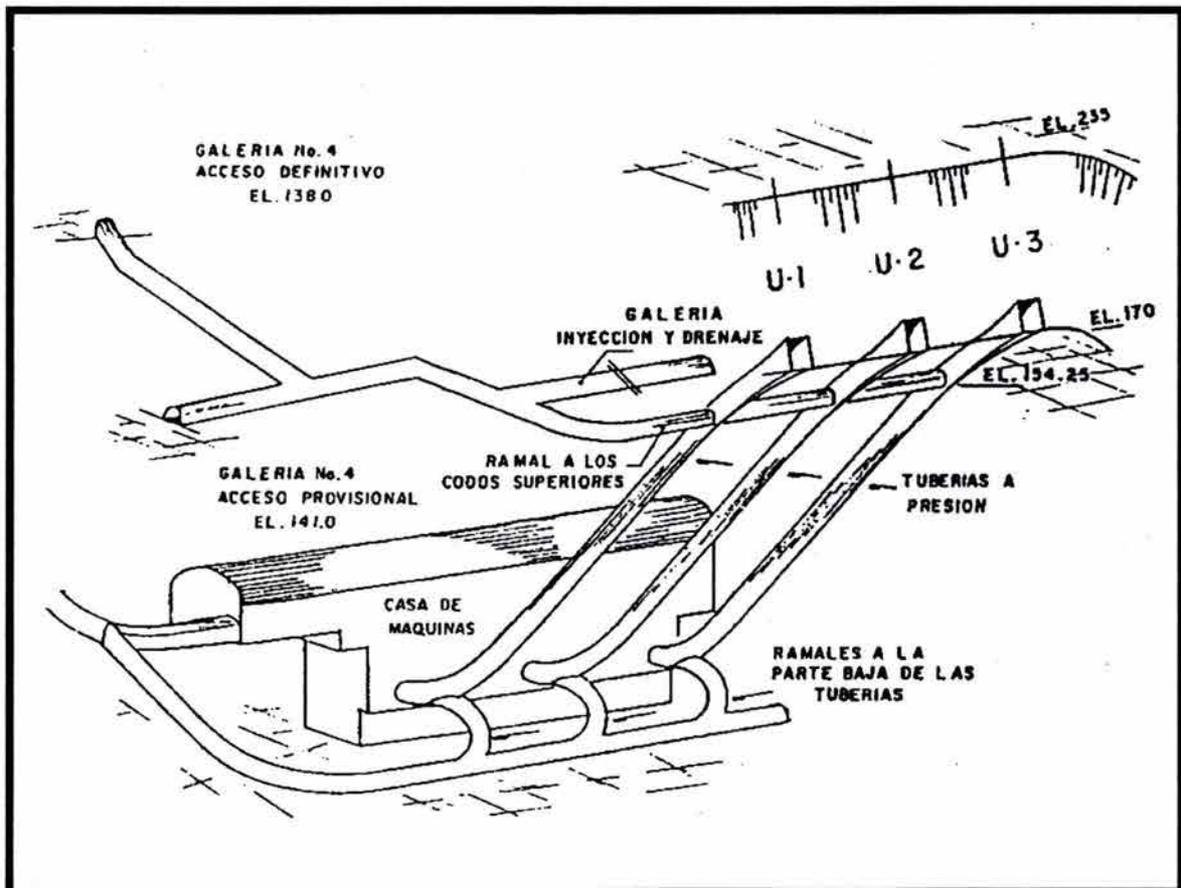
ACCESOS A LAS TUBERÍAS A PRESIÓN
